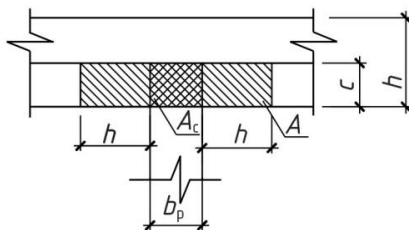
К расчету кладки на местное сжатие. В расчетную площадь A входит площадь смятия A_c
